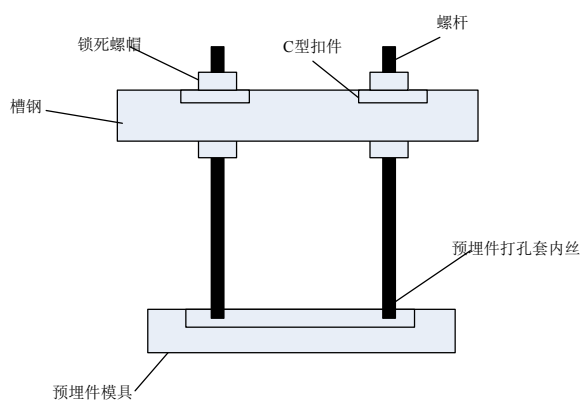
吊杆与预埋件无缝焊接连接固定剖面图
